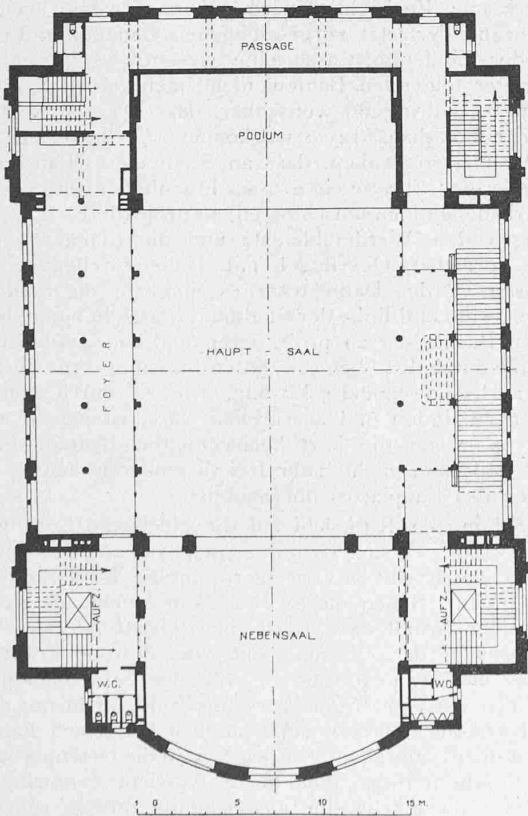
Grundriss vom I. Obergeschoss.
